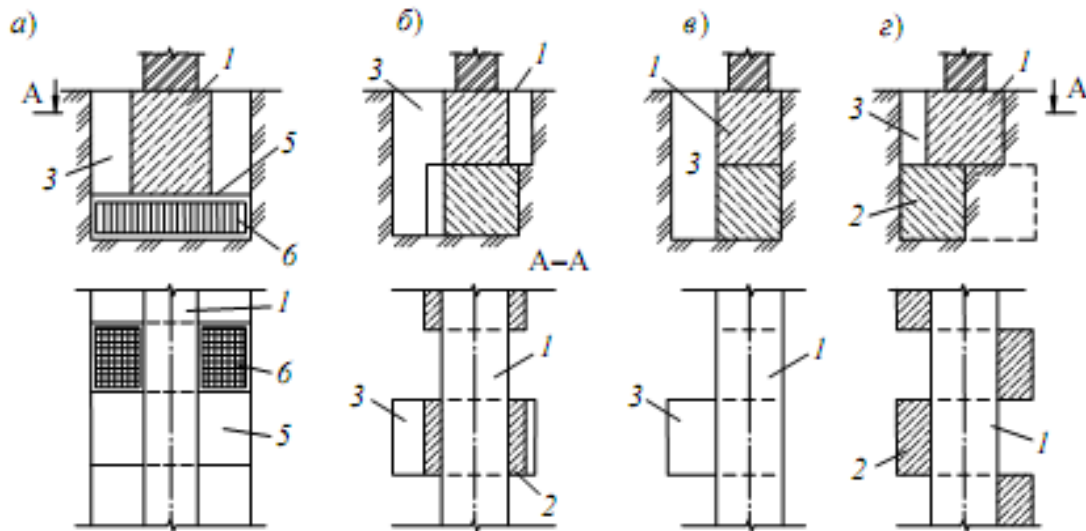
Варіанти посилення підведенням конструкції під фундаменти у вигляді: а - залізобетонних плит, балок; б, в - окремих стовпів; г - суцільної стіни:
